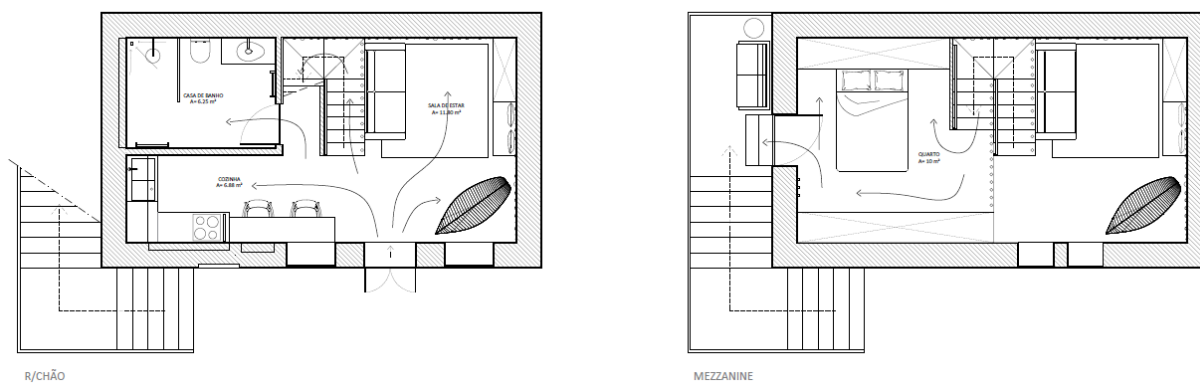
Planta de Zonamento e Circulação, Alojamento Til, Piso 1.
